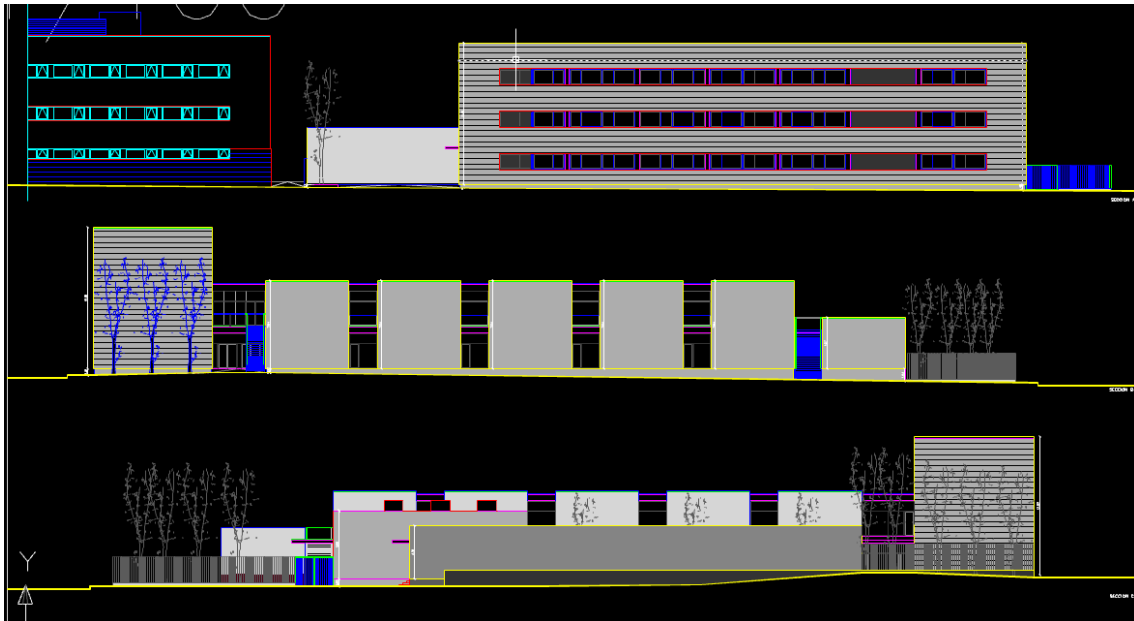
Extraído del plano de alzados perteneciente al proyecto de ejecución.
